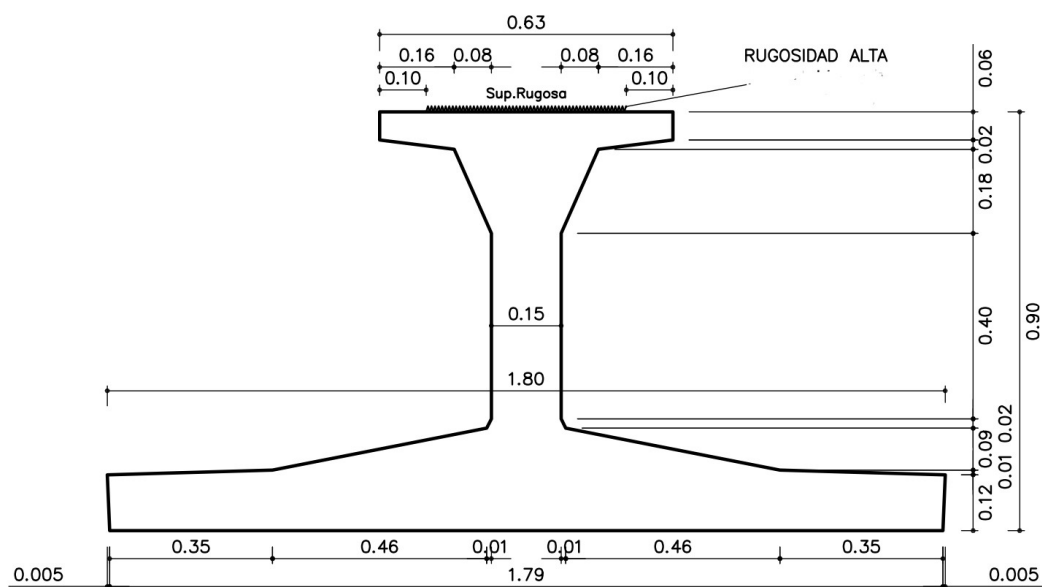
Sección tipo viga TPP-90 de Tierra Armada
